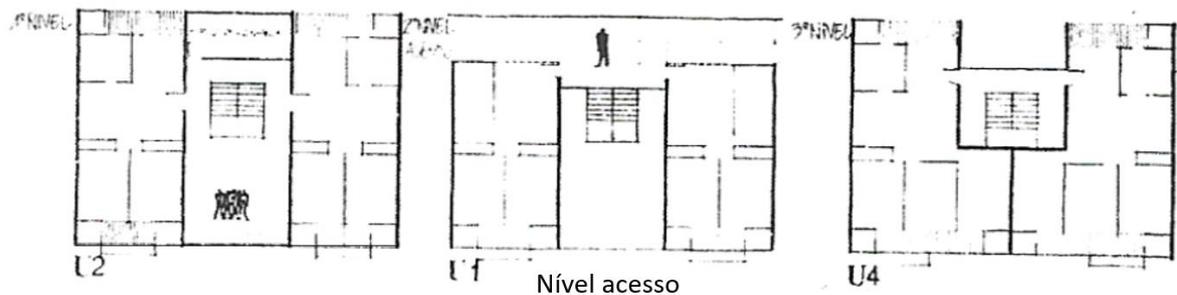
Estudo 01 – níveis acima do primeiro e segundo pavimento.
